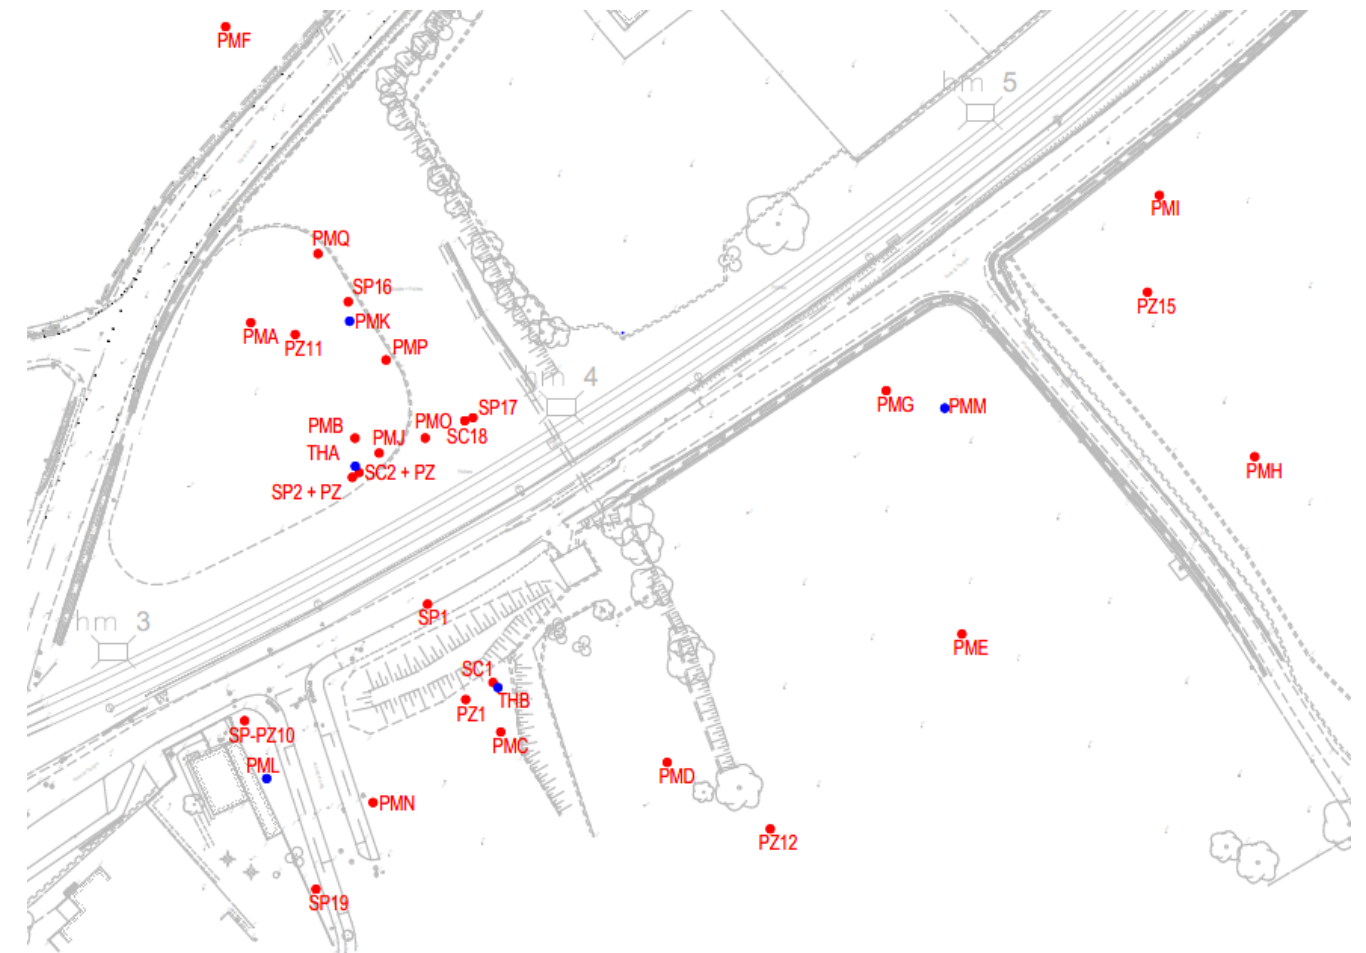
PLAN D'IMPLANTATION DES SONDES
